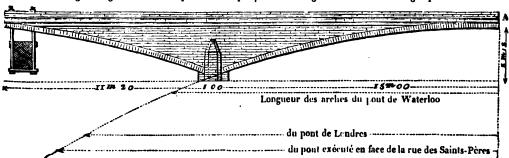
Demi-arches de Brunel, avec ciment de Parker.
